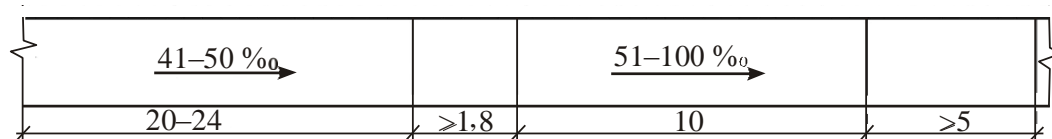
Пример планировки тротуара (пешеходной дорожки) с различными продольными уклонами
